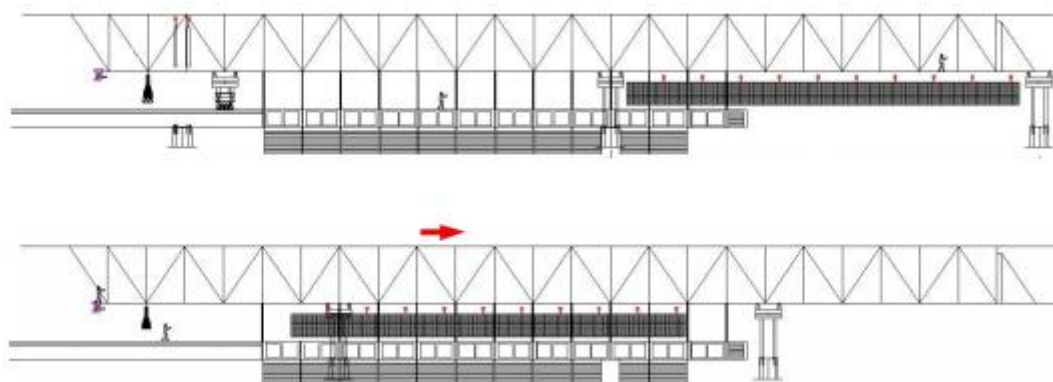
| 20 – Abertura da cofragem exterior e lançamento da viga [24]
